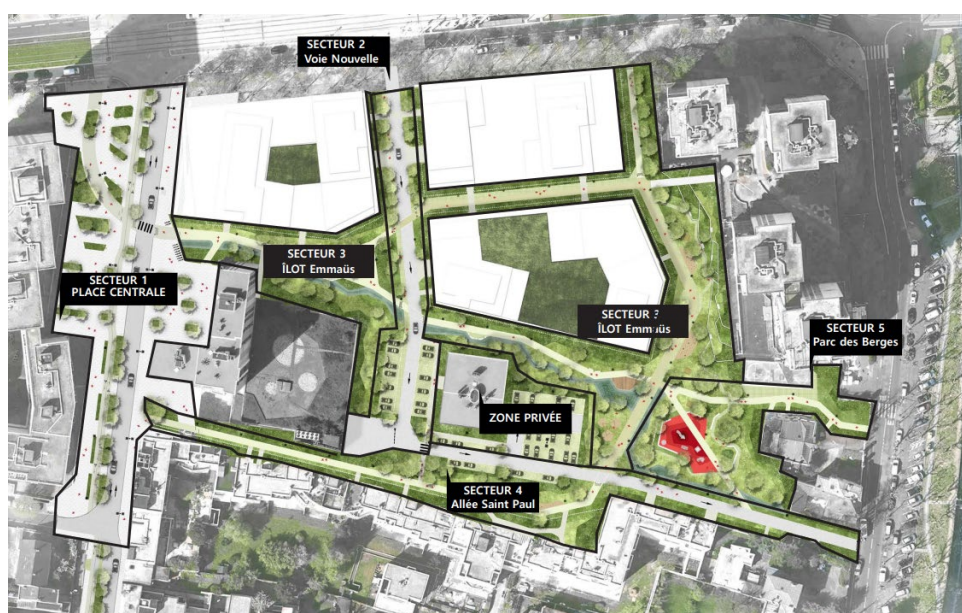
Plan des secteurs d'intervention pour les espaces publics (Endroits en vert – 2023)
